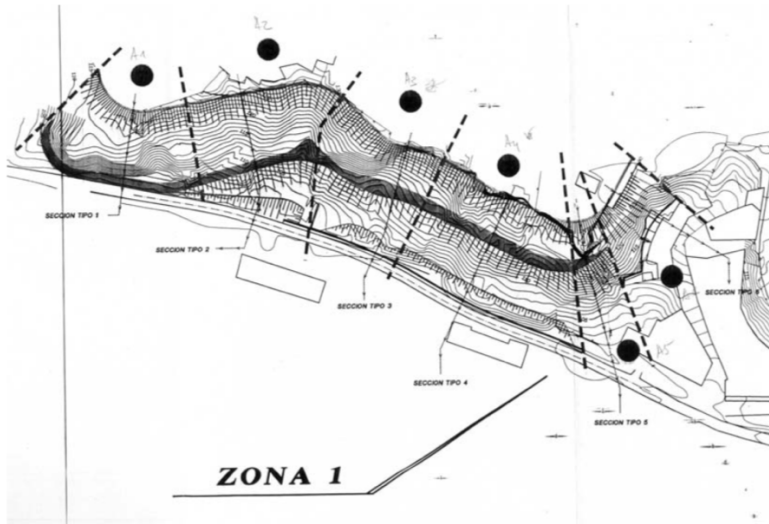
Planta con zonificación (1 de 2). Zona 1
